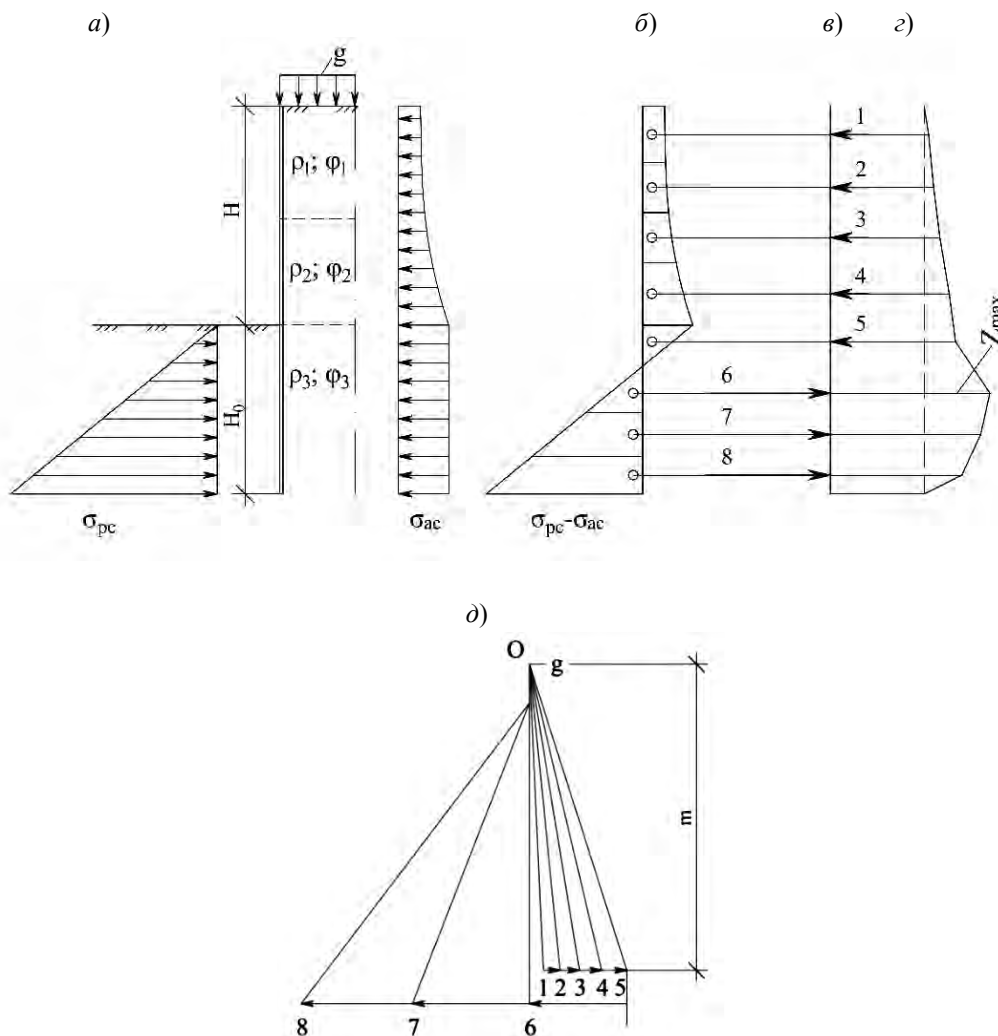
К расчету безанкерных шпунтовых стен графоаналитическим методом
